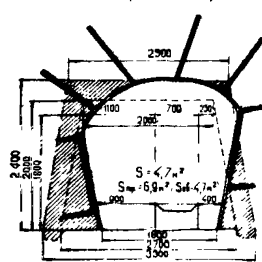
Рекомендуемые варианты крепления выработок, пройденных по породе, набрызг-бетоном в сочетании с анкерной крепью
